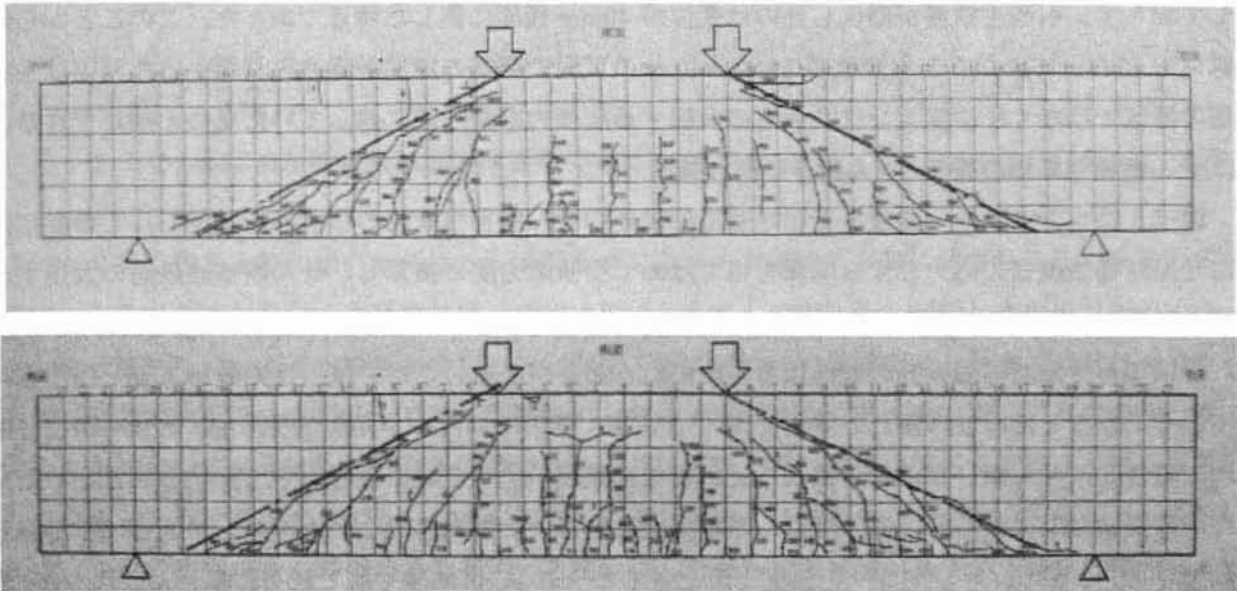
供試体に発生したひび割れ状況(上：供試体 B-1、下：供試体 B-2)
